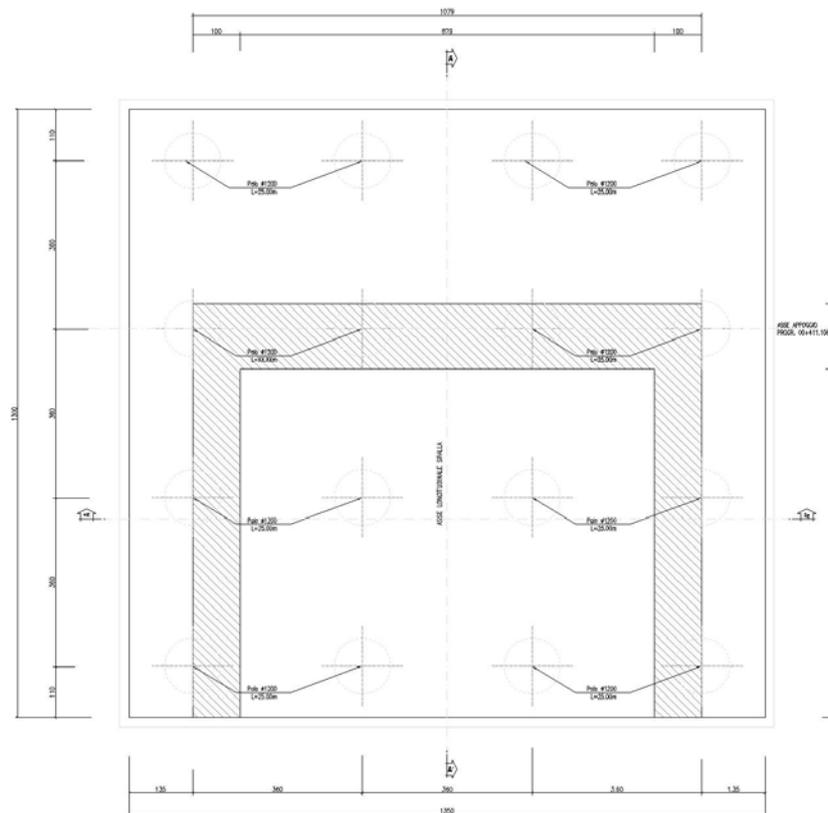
Pianta spiccato fondazione della spalla B.
